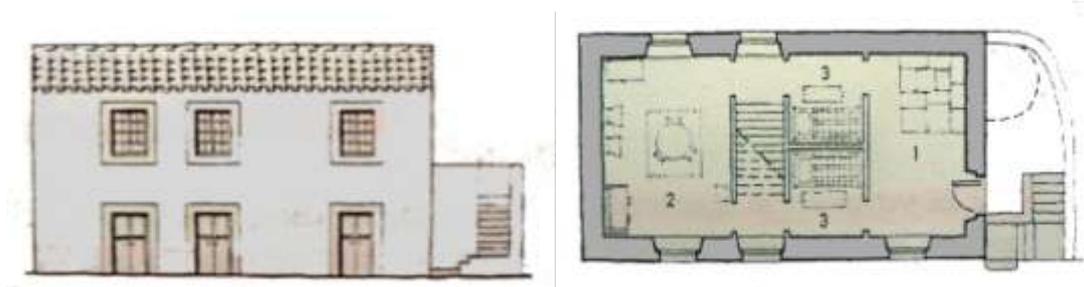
Casa linear açoriana: alçado e planta (TOSTÕES et al, 2000).
